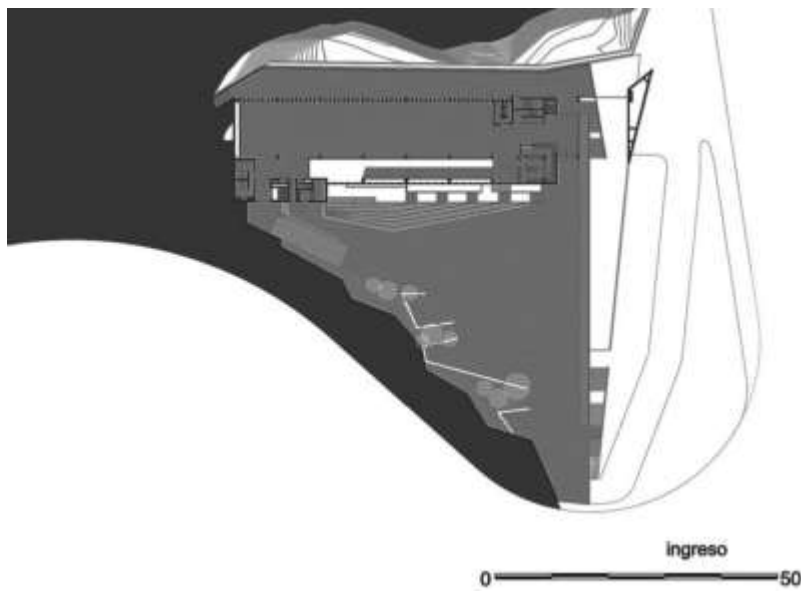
LUM. Planta nivel de ingreso.+0.00 m. Estudio Barclay & Crousse
